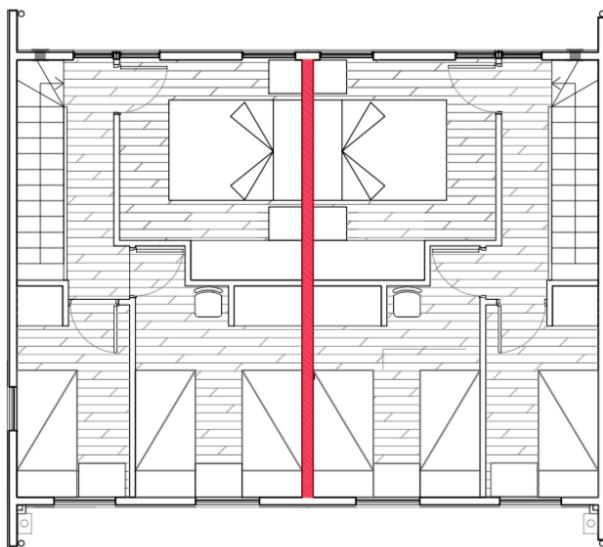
planta segundo piso arquitectura proyecto vivienda dos pisos, Osorno.
